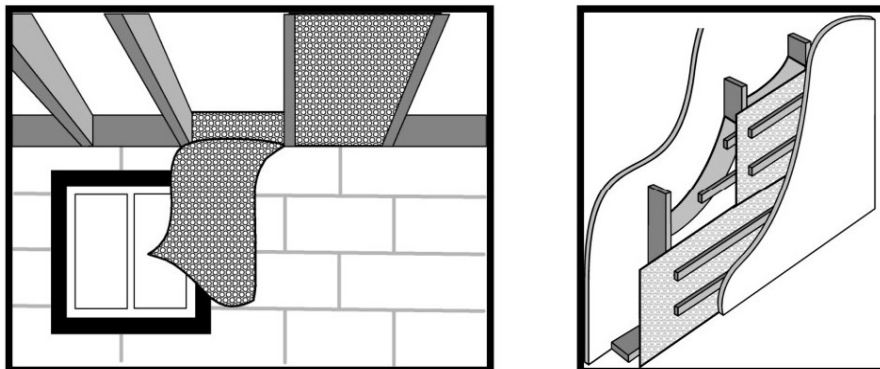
Ubicación de barrera radiante en cámaras de aire horizontal y vertical
